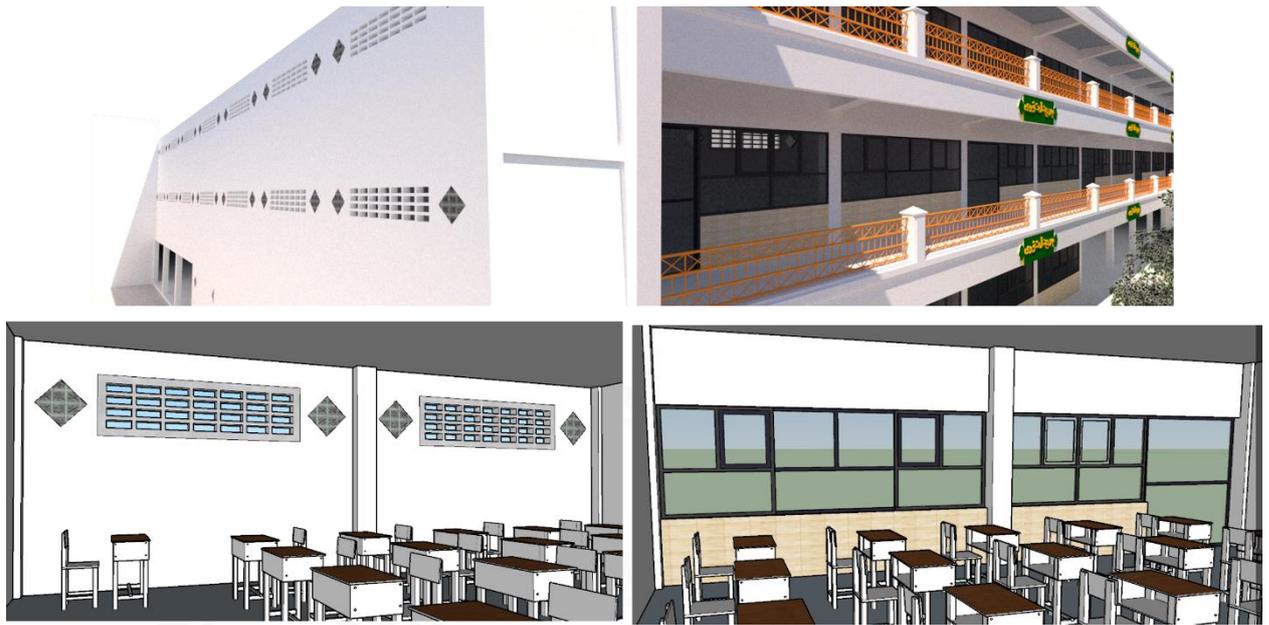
63 Ruang kelas SD lantai 2 eksisting
